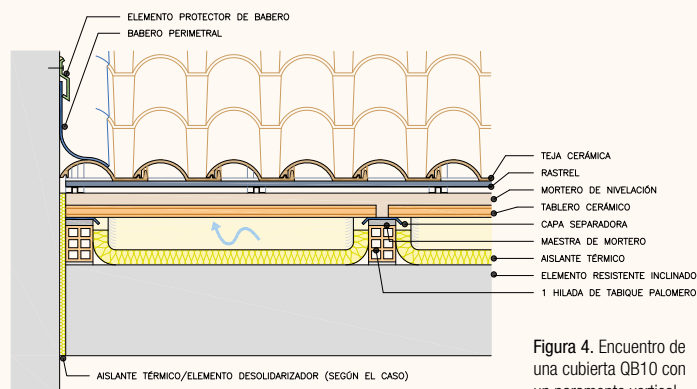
Encuentro de una cubierta QB10 con un paramento vertical.
